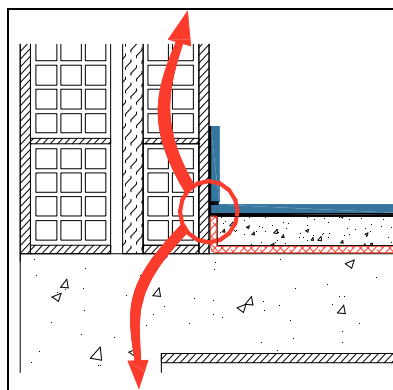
esempio di posa errata della pavimentazione a diretto contatto con la parete
